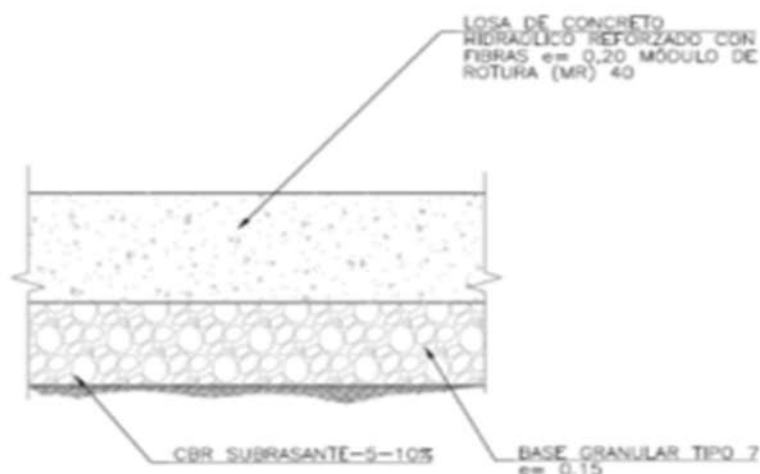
Detalle constructivo de la estructura pavimento rígido.
